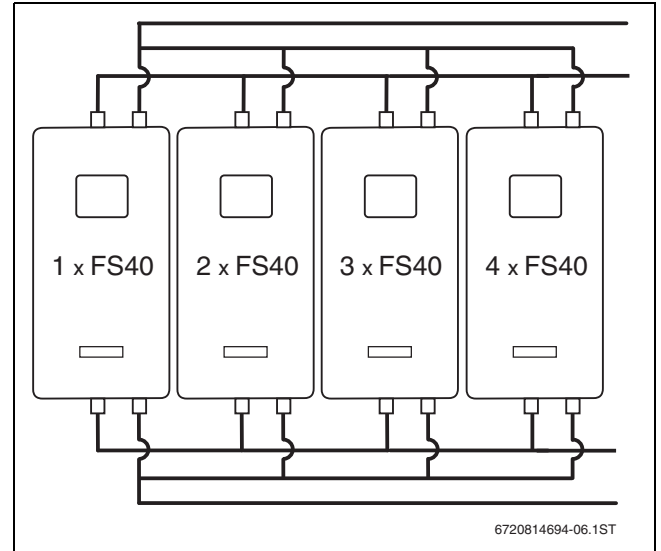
Stationen bauseits verbinden (Beispiel: Anschlussseite rechts mit FS40)
